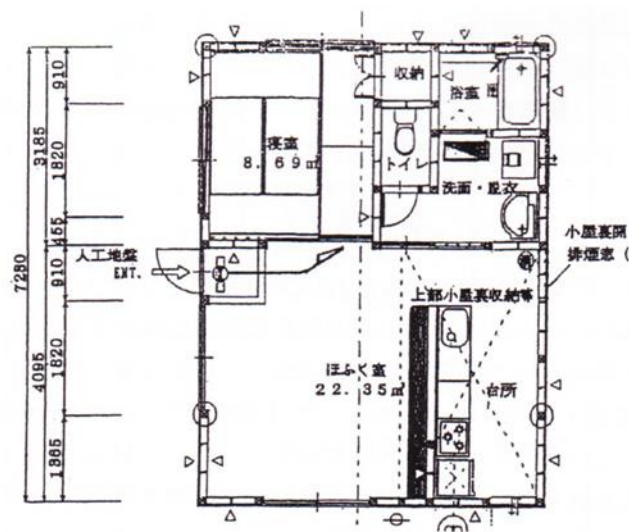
乳児院併設の小規模グループケア施設（らら）の平面図
